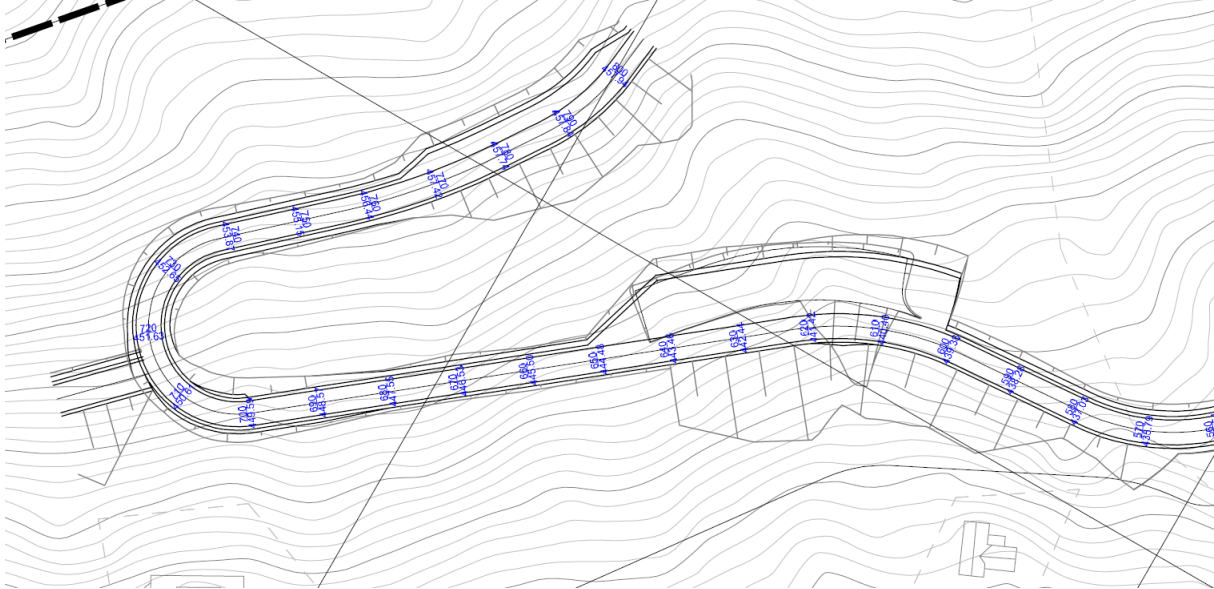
Vegplan SKV2 i omdiskutert område. Skjering vert ikkje stor. Sjå profil 650 i dette området under. Muren er på det høgaste i profil P700.
